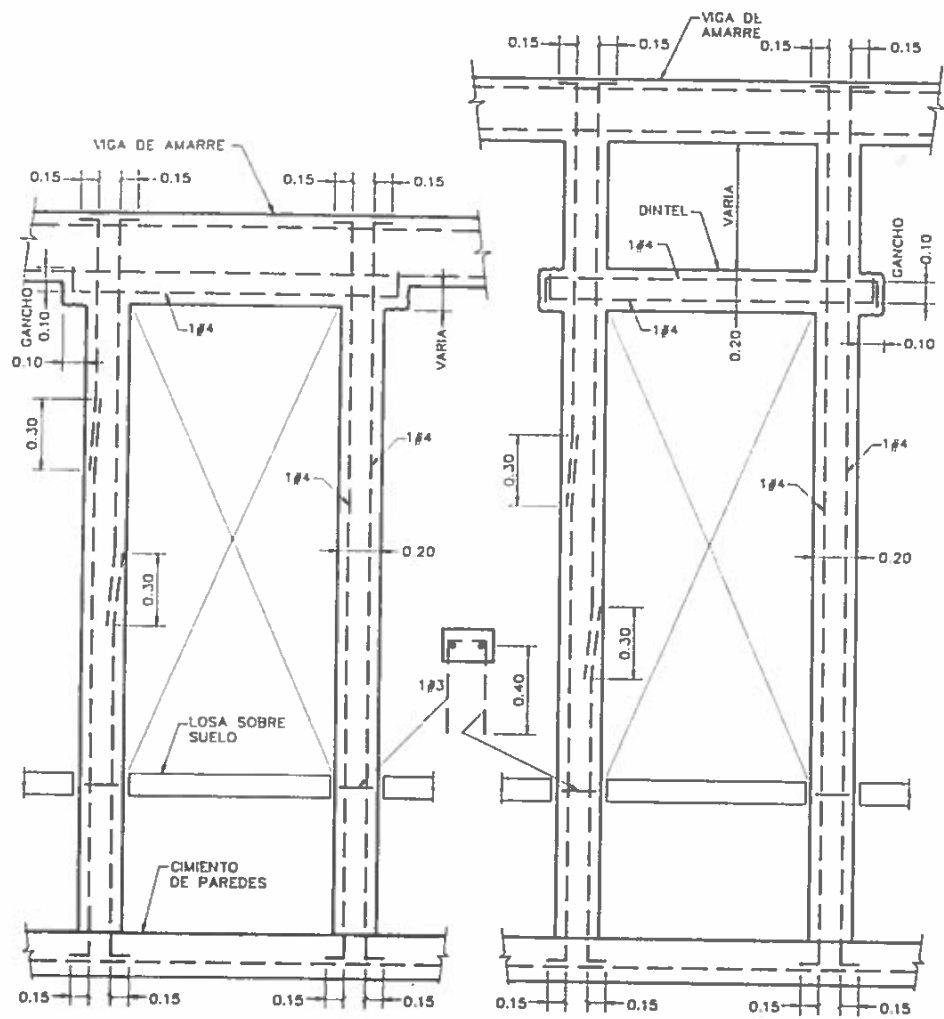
REFUERZO ALREDEDOR DE PUERTAS
